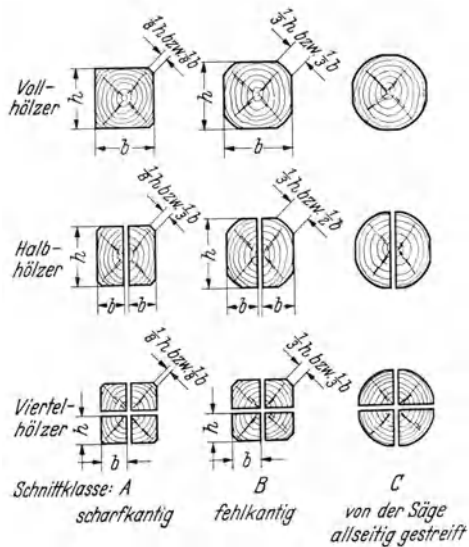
Zulässige Lage und Breite der Fehlkante nach DIN 4074.
